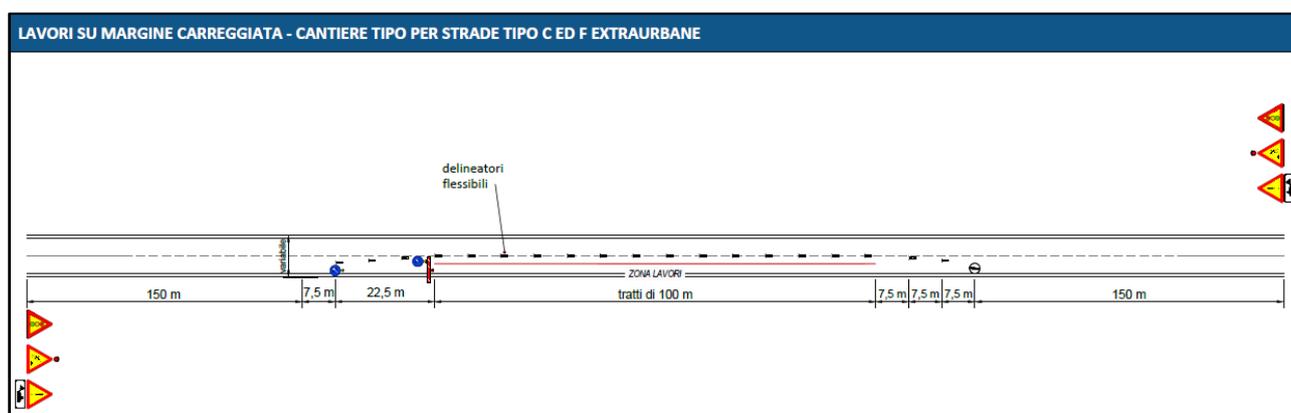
Schema tipo di organizzazione del cantiere per la posa del cavidotto interrato su strada
